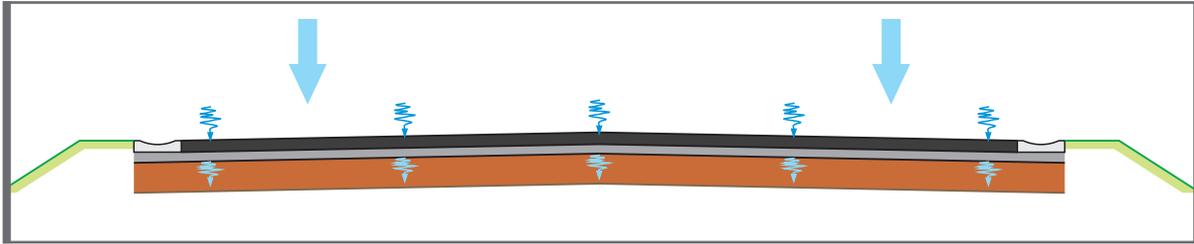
Infiltration d'eau par les joints et/ou fissures du revêtement
